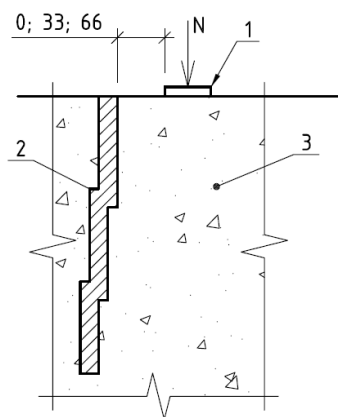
Схема проведения испытаний с моделью разделительной стенки: 1 – штамп; 2 – модель разделительной стенки; 3 – уплотненный грунта (песок)
